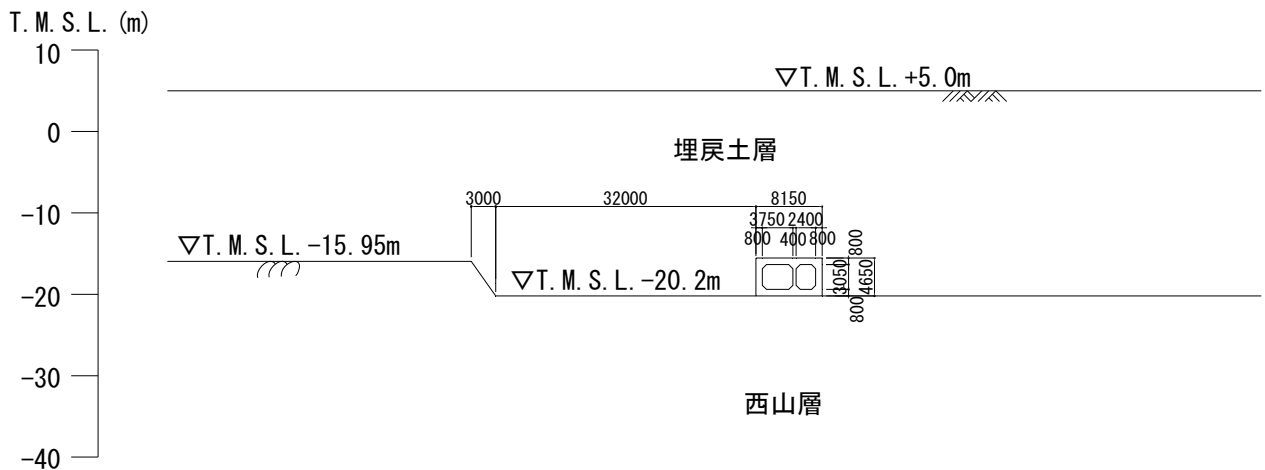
原子炉補機冷却系配管ダクト (A系) 断面図 (B-B断面)
